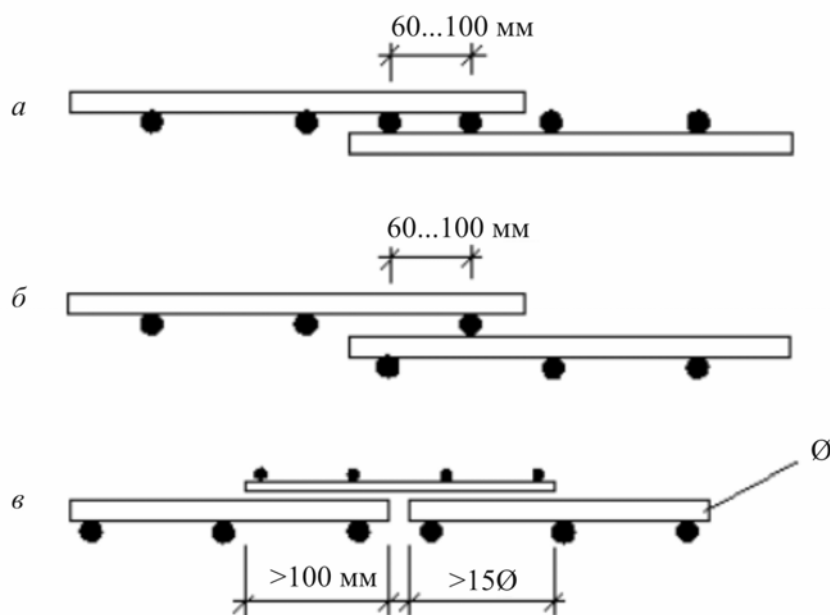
Схемы соединения арматурных сеток без сварки в направлении распределительной арматуры: *а* — при диаметре распределительной арматуры 4 мм и менее; *б* — то же более 4 мм; *в* — при применении стыковой сетки с перепуском
